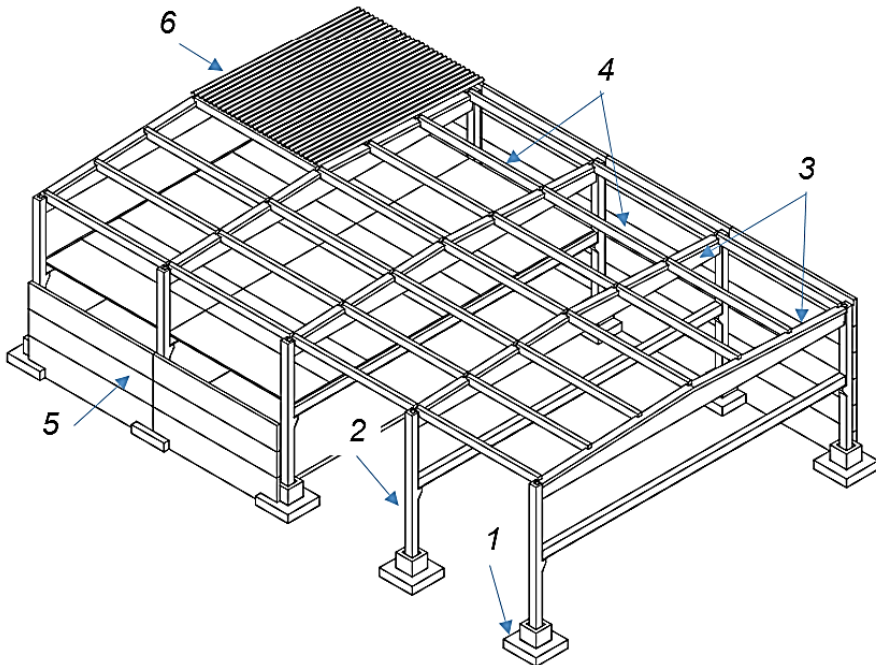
Каркасна одноповерхова будівля з поперечним розташуванням збірних рам з залізобетонних конструкцій:
